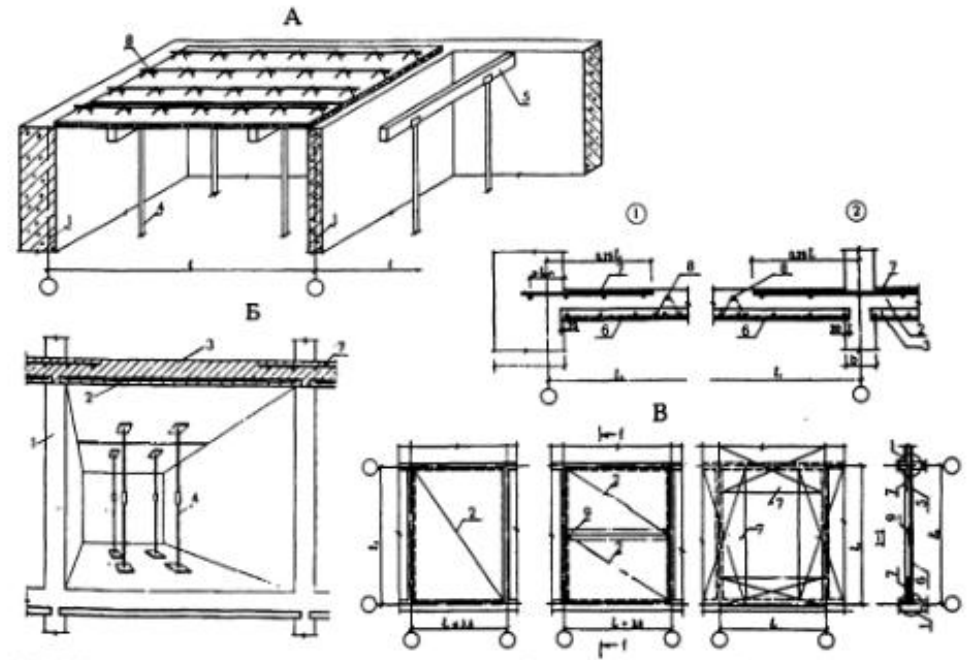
Сборно-монолитное перекрытие: А - установка сборных тонких железобетонных "скорлуп", выполняющих роль несъемной опалубки; Б - замоноличивание плиты; В - схема раскладки "скорлуп" и верхних арматурных сеток; 1 - монолитная стена; 2 - "скорлупа"; 3 - монолитная часть; 4 - телескопическая стойка; 5 - опорный брус; 6 - нижняя арматурная сетка; 7 - верхняя арматурная сетка; 8 - каркас "скорлупы"; 9 - арматурная сетка на стыке "скорлуп"
